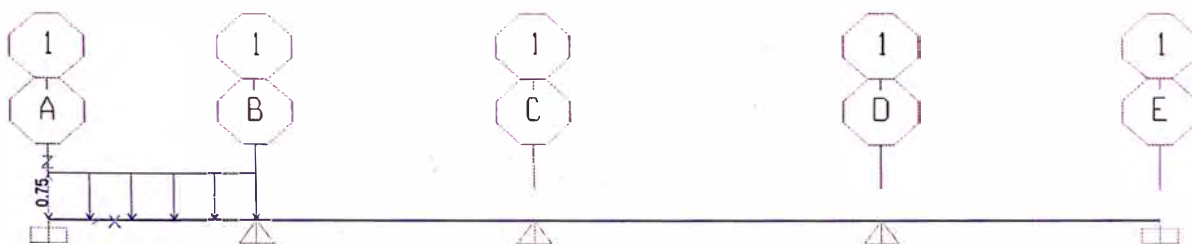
Carga viva en la viga (tramo 1). Fuente: SAP2000.
